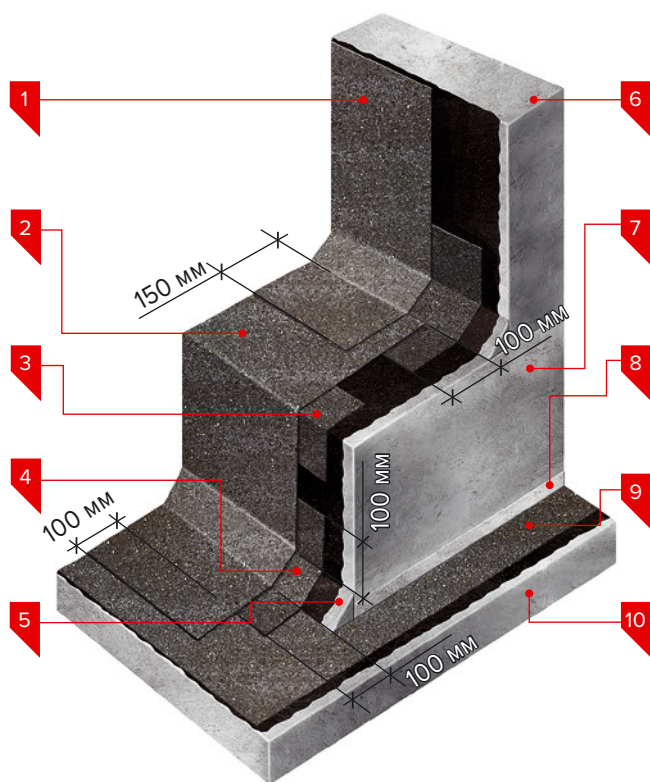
Техноэласт Фундамент ГИДРО. Зона подошвы фундамента. Вариант сплошной приклейки к основанию:
